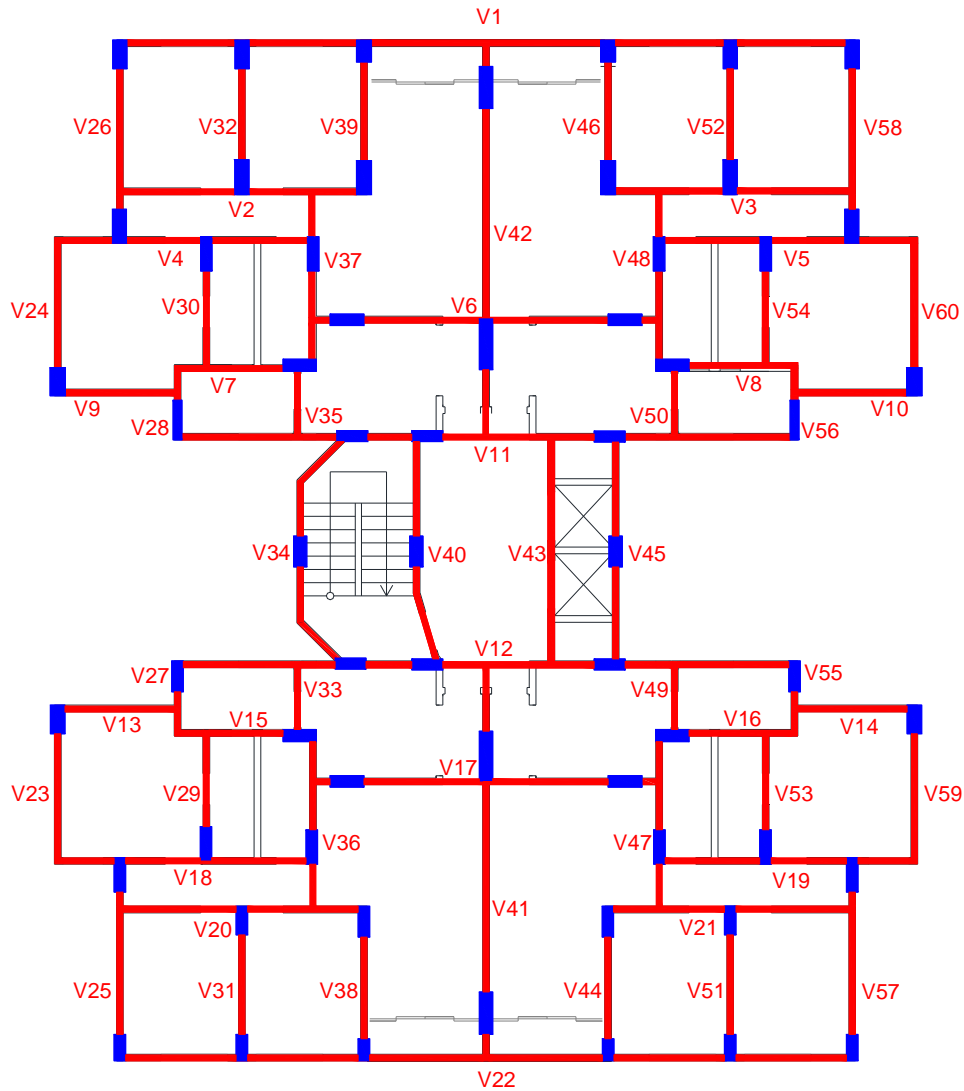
Localização dos pilares e vigas – Residencial Casemiro Bôscoli.
